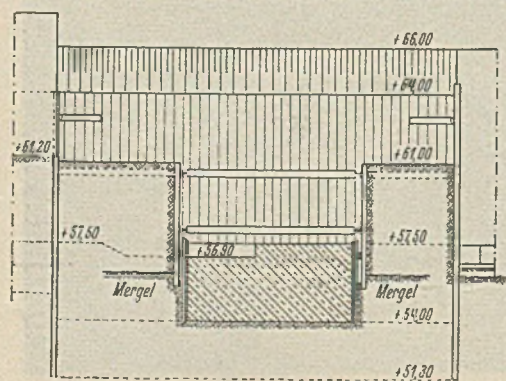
Aussteifung der Baugrube des Unterhauptes. Längsschnitt.
